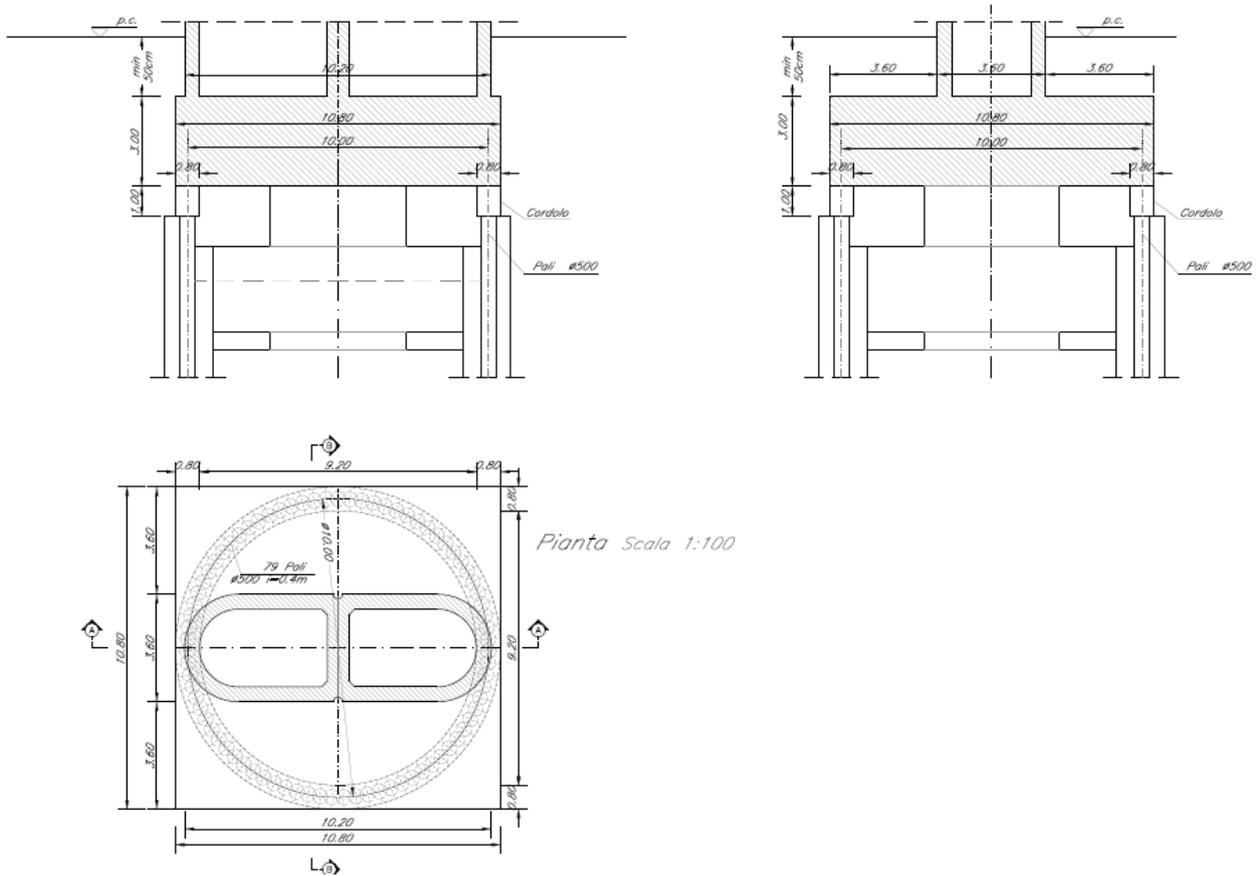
stralcio carpenteria fondazione con singolo pozzo di fondazione circolare di diametro 10m
